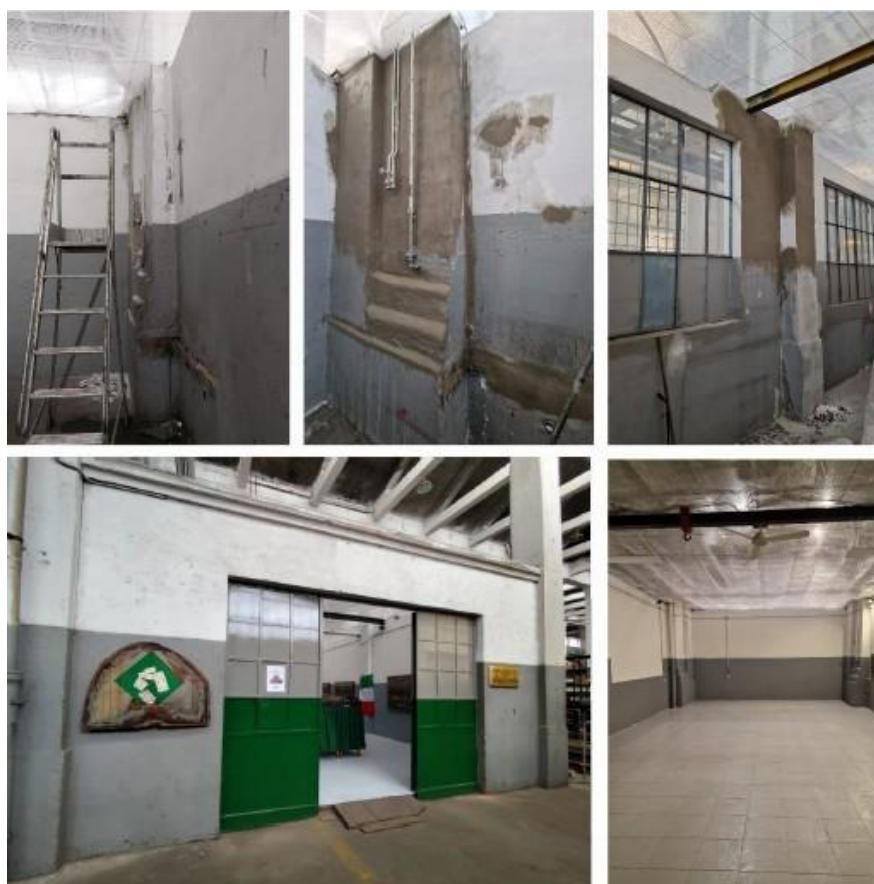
Ristrutturazione dello spazio destinato a esposizione fermodellistica denominato “Sala Settebello”
